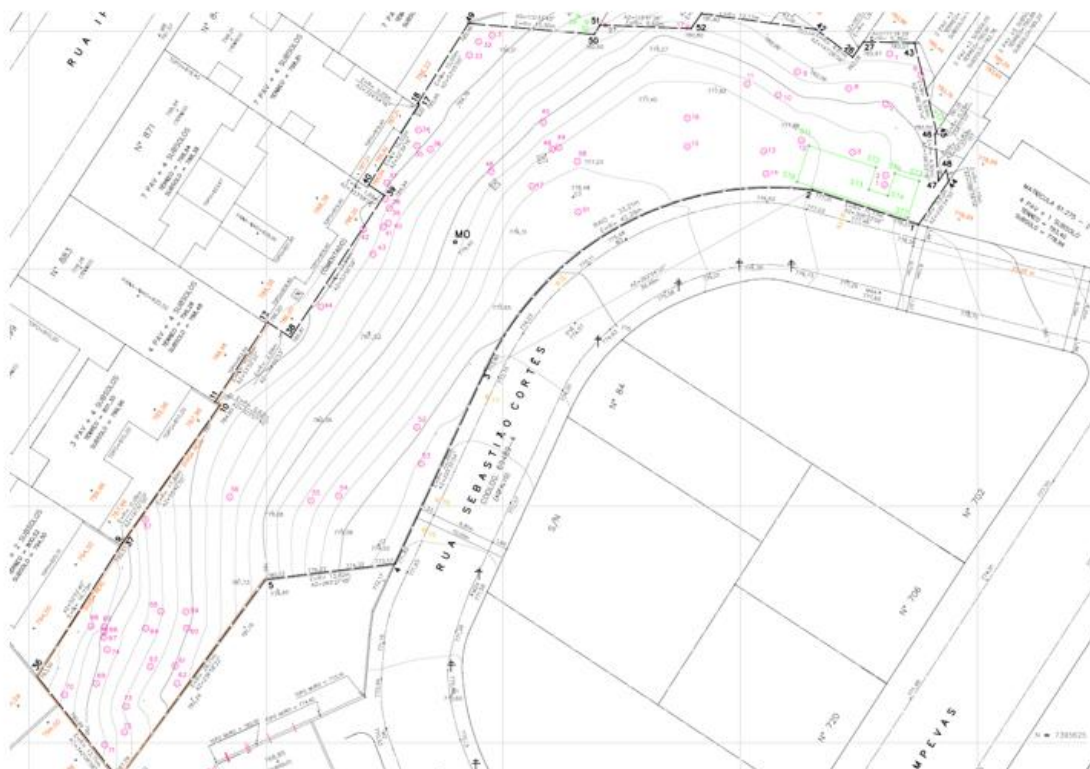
Levantamento planialtimétrico atualizado do terreno, escala 1:100.
